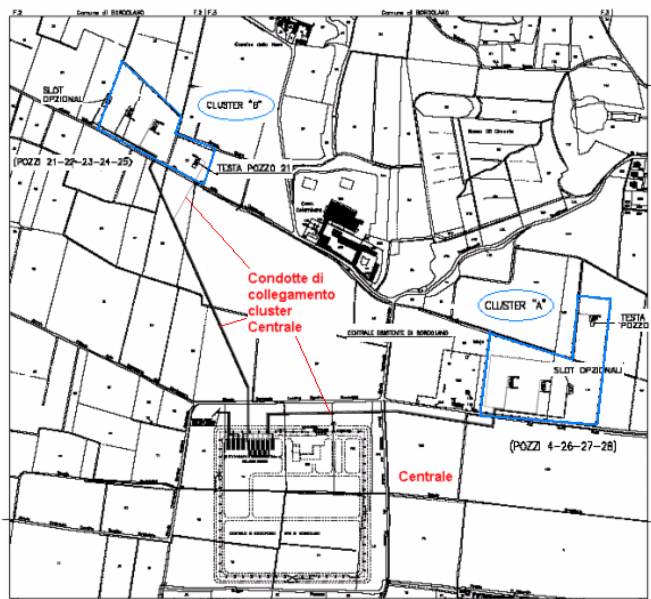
a – Planimetria generale con ubicazione delle opere in progetto
